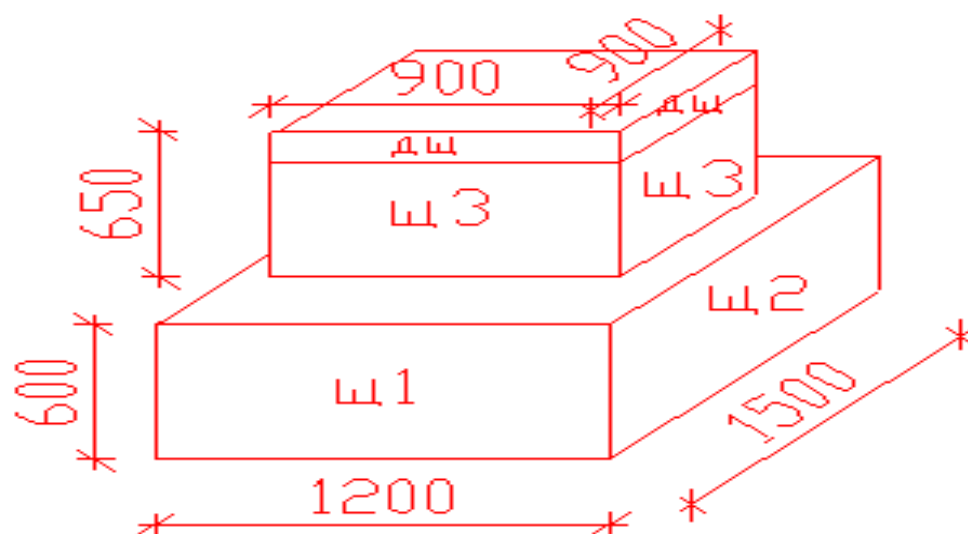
Схема раскладки щитов столбчатого фундамента
